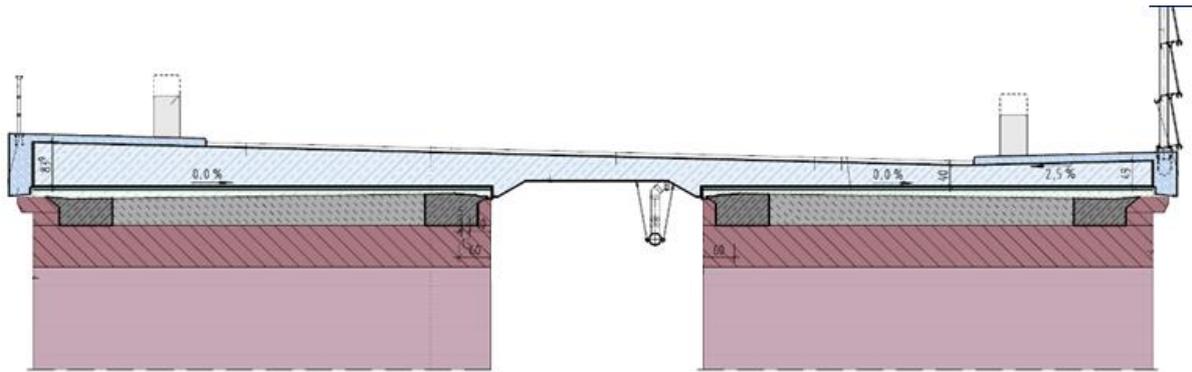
Stahlbetonfahrbahnplatte über den bestehenden Bogenbauwerken
